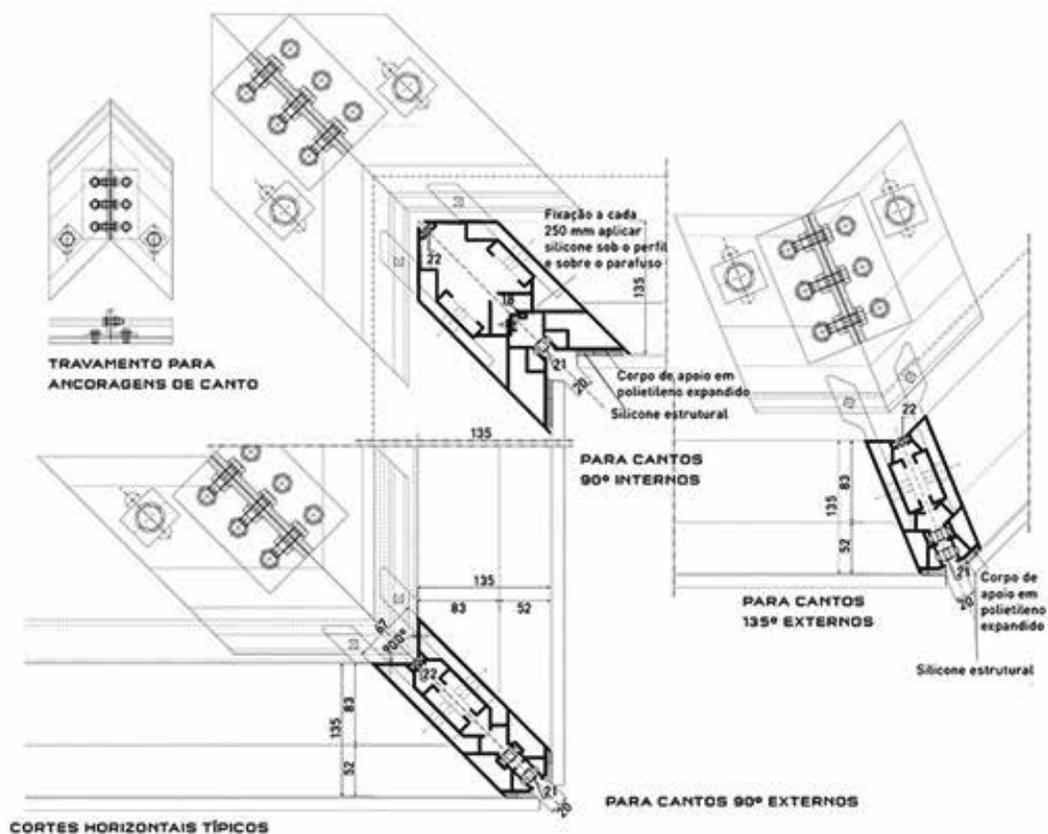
Detalhes do sistema Unitizado e suas fixações. (GELINSKI, 2013a)
